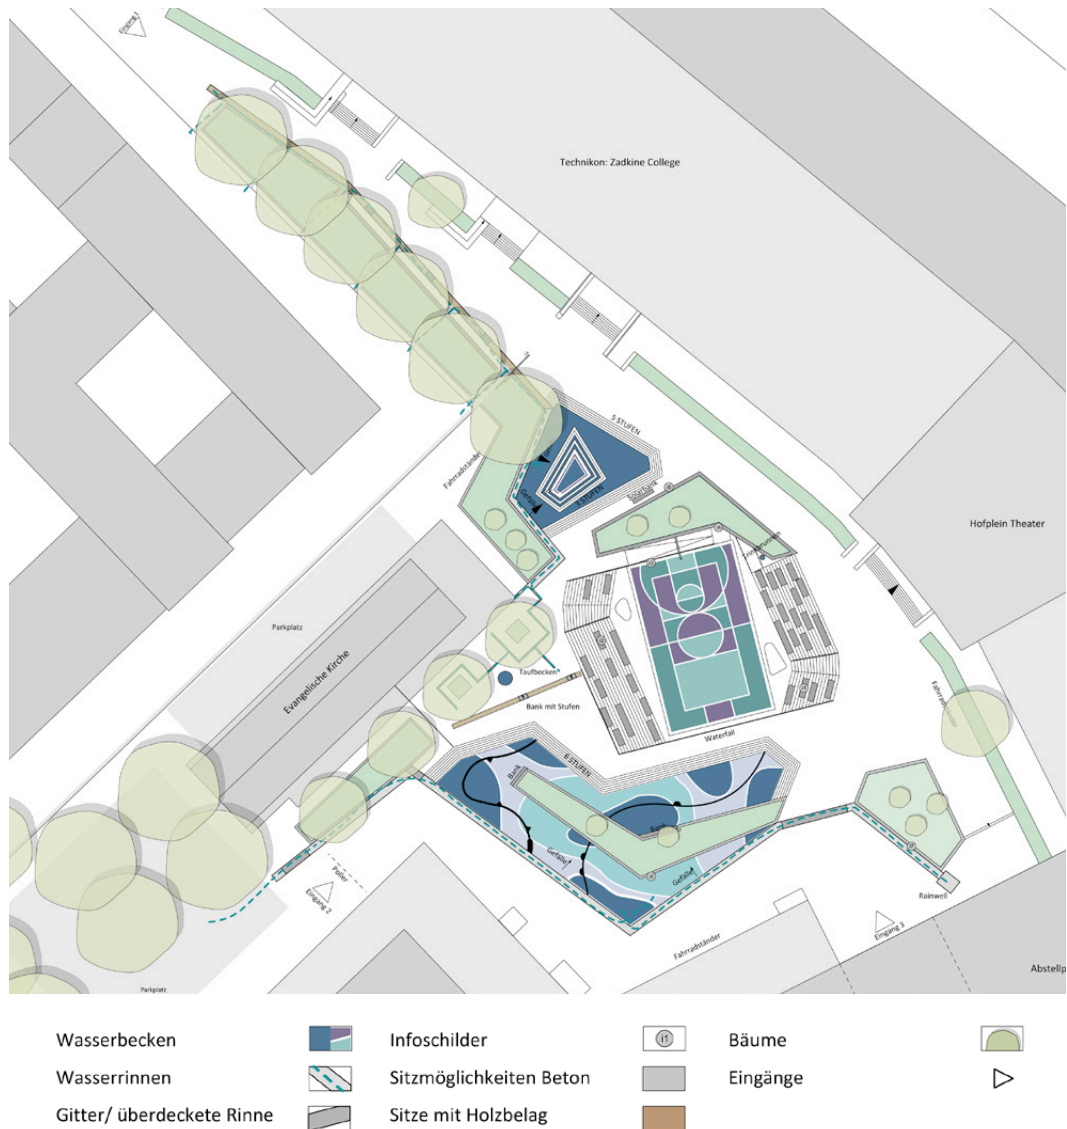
Lageplan Bentheplein (Eigene Darstellung nach Lageplan De Urbanisten, Luftbild und Vor-Ort Aufnahme)
